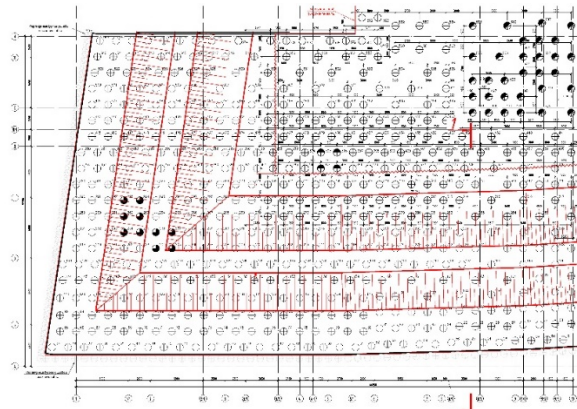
Фрагмент план расположения буронабивных свай и берм
